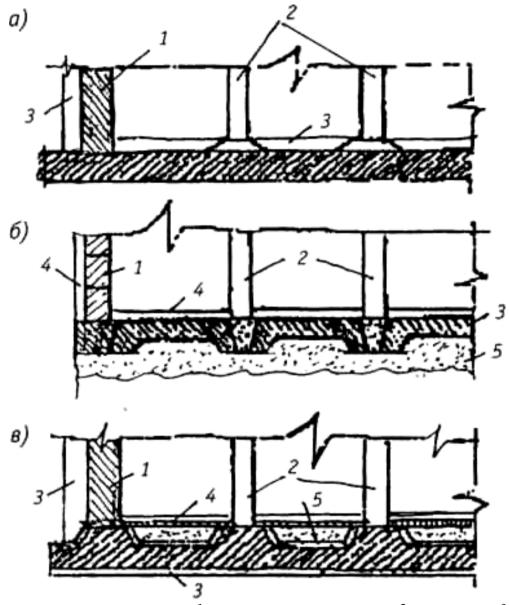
Фундаменты из крупных панелей: a- в виде плоских железобетонных панелей; 1- фундаментный блок-подушка; 2- сквозная рама; 3- покольная стеновая панель; 4- перекрытие; 5- плоская фундаментная панель
